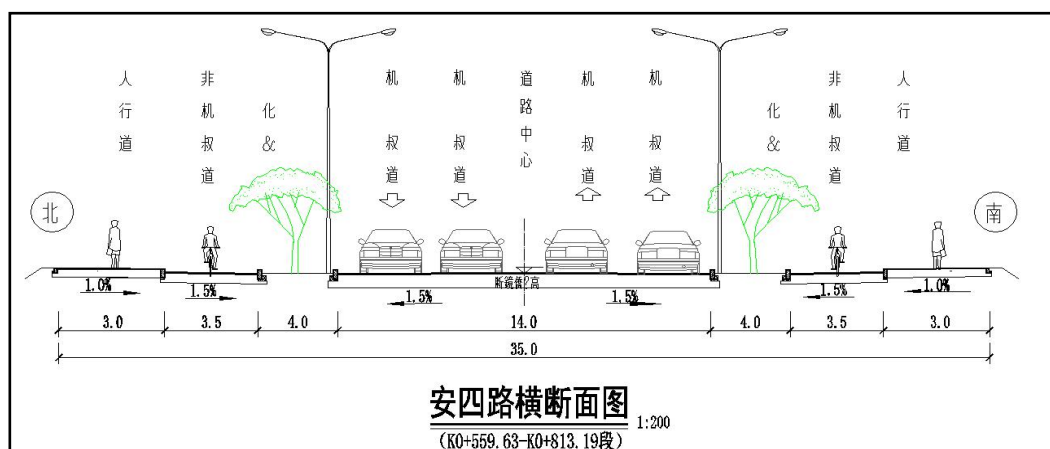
施工图阶段安四路 (k0+559-613) 段横断面方案设计图
